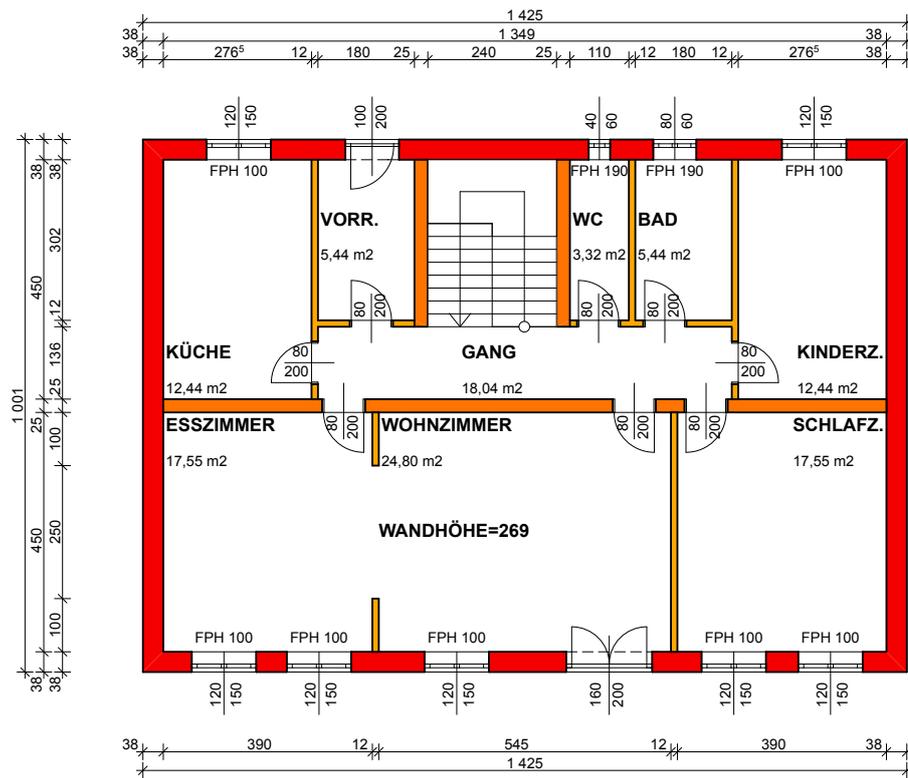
Grundriss Erdgeschoss
